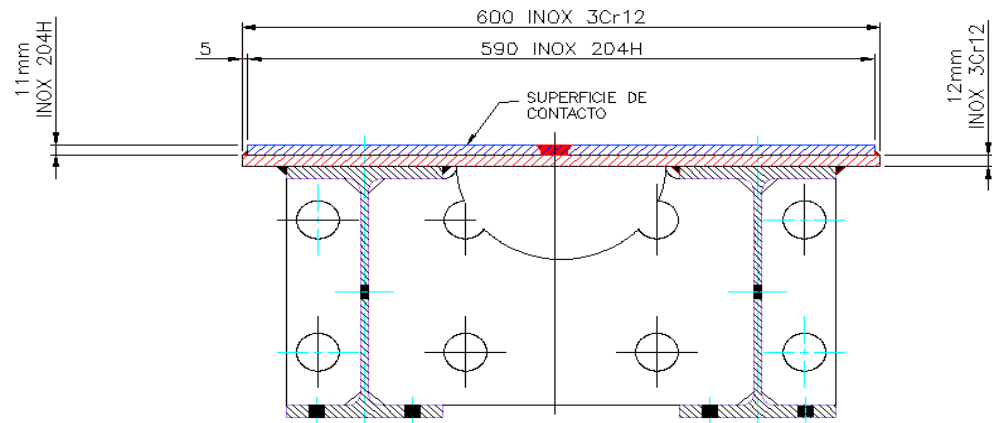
Se aprecia los materiales inoxidables 3Cr 12, 204H y la estructura del blindaje solera de segunda fase (vigas "H"). Fuente: Propia.
